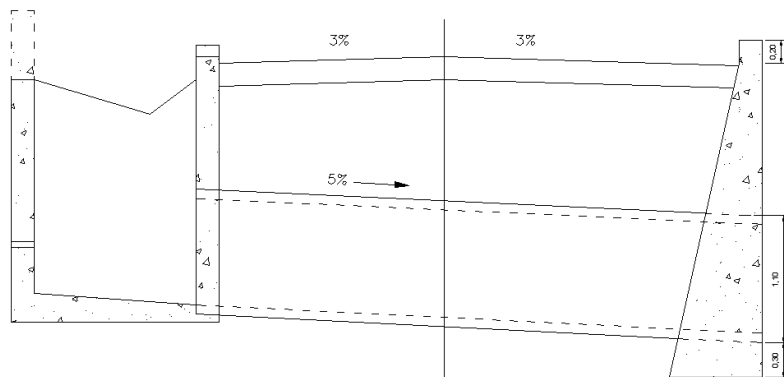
Sección transversal de la alcantarilla (Sección A-A)
